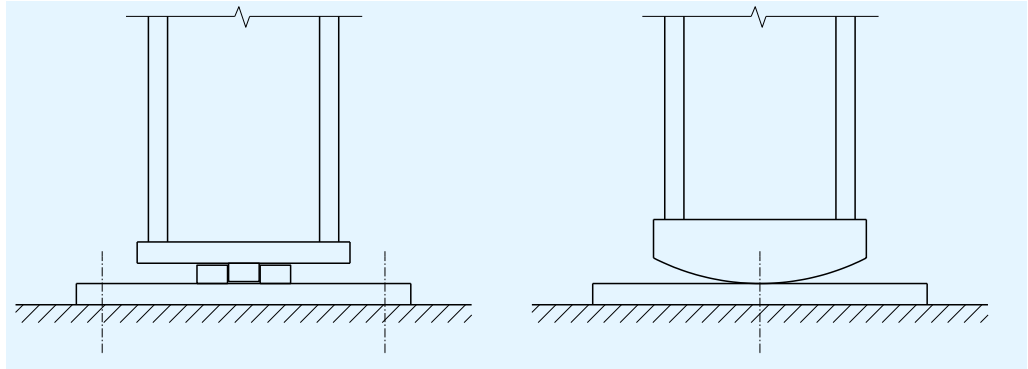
Exemples de pieds de poteaux à rigidité nulle
